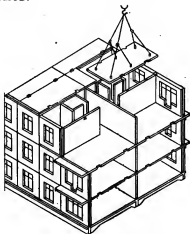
Конструктивная система бескаркасного здания. Панельные столбы вертикальных диафрагм связаны непосредственно плитами перекрытий
